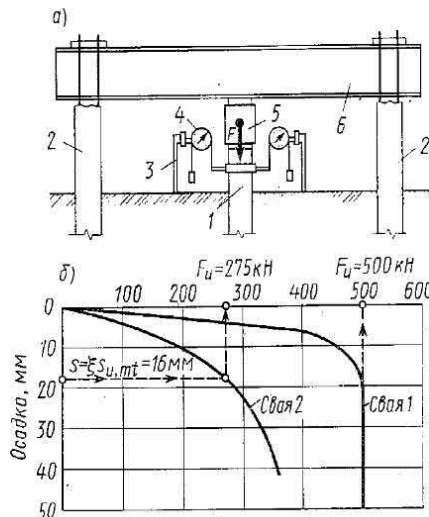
Испытания свай вертикальной статической нагрузкой:
